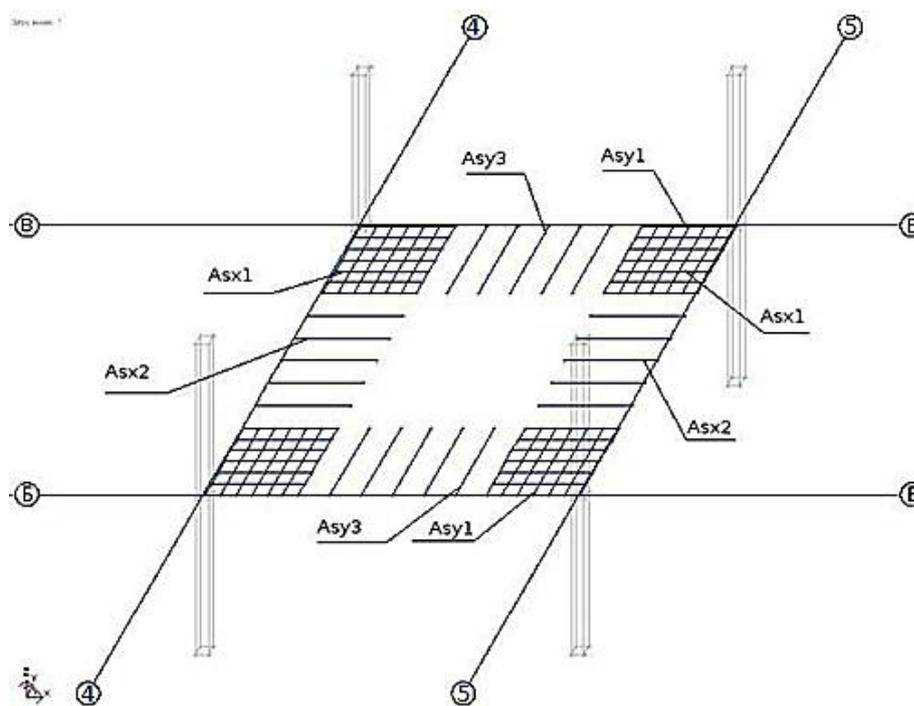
Схема верхнего армирования плиты перекрытия
